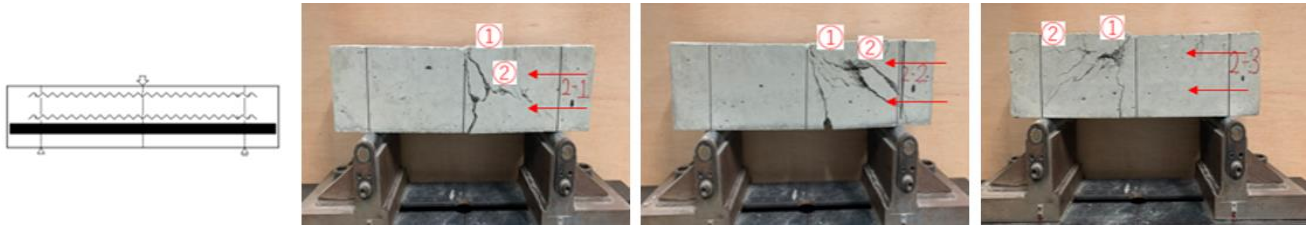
(g) 下から 37mm, 70mm ひび割れ
